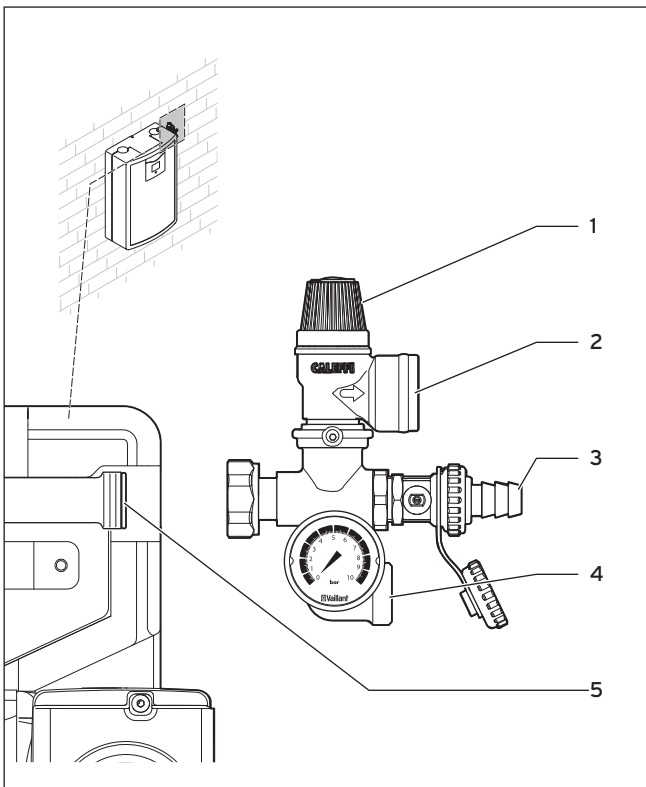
Collegamento del gruppo di sicurezza alla stazione solare
